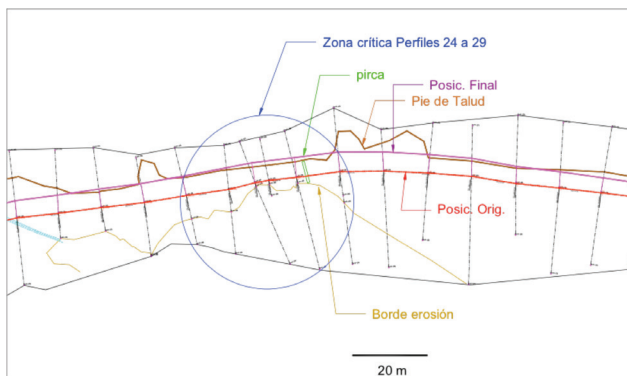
Detalle del relevamiento topográfico en planta en la zona crítica de la erosión que muestra la posición original de la tubería y su proyección final calculada por API 1117. Obsérvese en la zona crítica ya la tubería en el interior del macizo.
